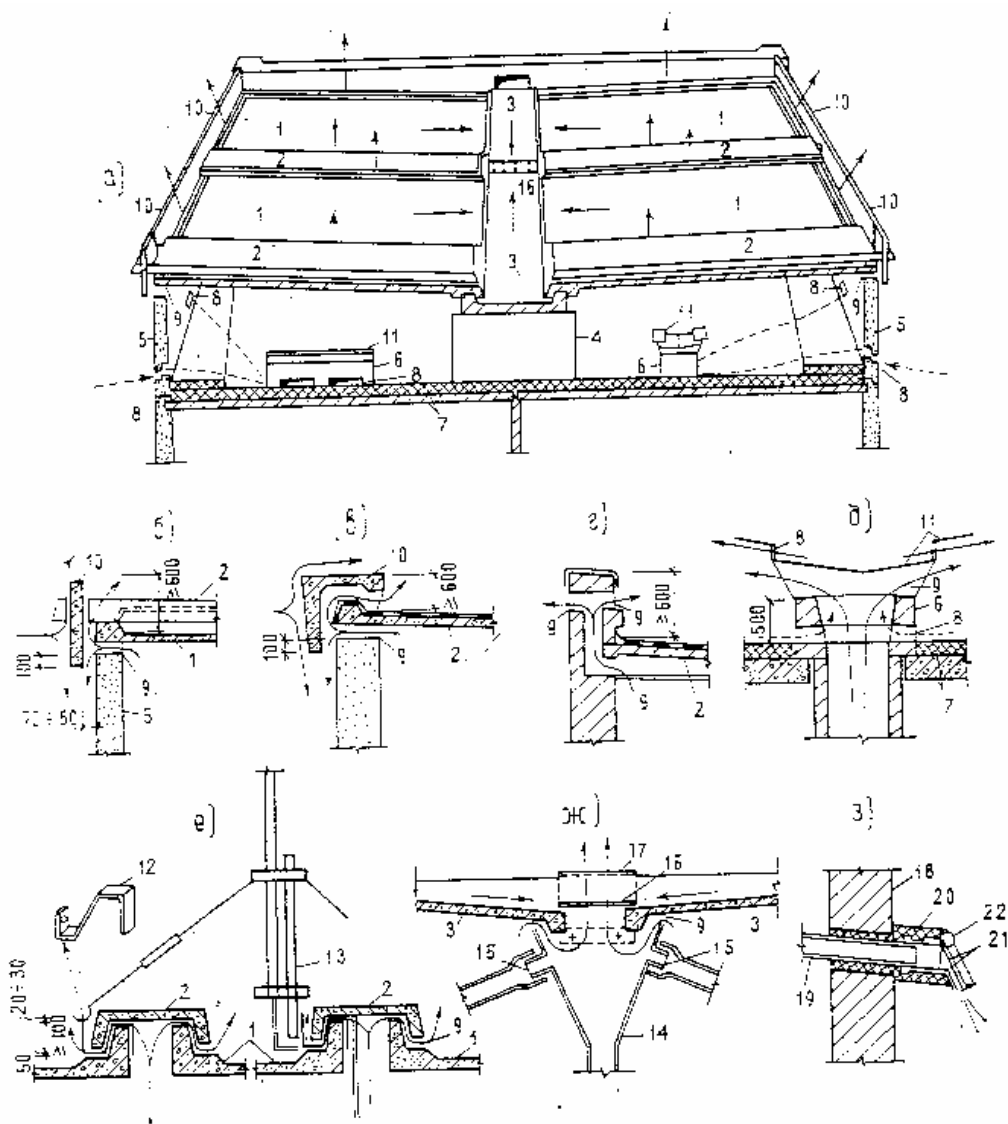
Конструкции крыши с открытым чердаком: а – общий вый; б, в, г – карнизные узлы; д – оголовок вентиляционного блока; е – продольные вентилируемые стыки кровельных панелей и детали крепления теле- и радиостоек; ж – устройство воронки внутреннего водостока; з – устройство открытого выпуска стока внутреннего водостока; 1 – скатные кровельные панели; 2 – нащельные панели; 3 – лотки внутреннего водостока; 4 – опорные блоки; 5 – фризные панели; 6 – оголовки вентиляционных блоков; 7 – утепленное чердачное перекрытие; 8 – приточные отверстия; 9 – вытяжные отверстия; 10 – экраны-парапеты; 11 – деталь крепления основания теле- и радиостойки оттяжки; 12 – основание теле- и радиостойки; 13 – основание теле- и радиостойки; 14 – чаша воронки внутреннего водостока; 15 – патрубки для подсоединения объединенных фановых труб; 16 – решетка воронки; 17 – подвеска воронки; 18 – цоколь; 19 – открытый выпуск стояка внутреннего водостока; 20 – утепленный прямоугольный патрубок; 21 – крышка с уплотнительными приливами и прокладкой; 22 – шарнир – упрощение и облегчение конструкции покрытия, выполняемого из тонкостенных панелей без теплоизоляции;
